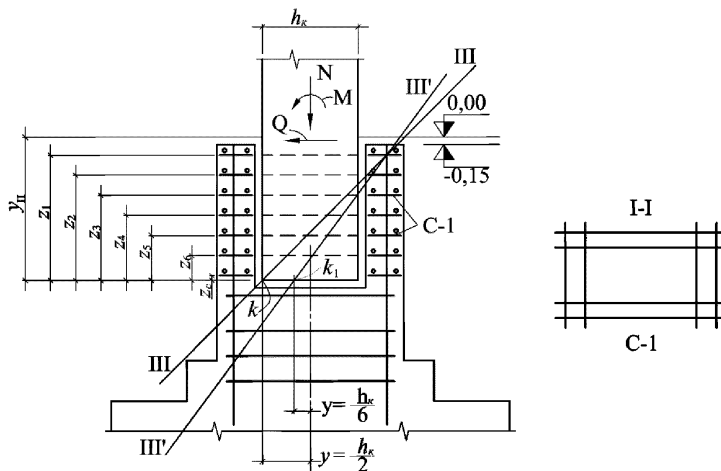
Расчетная схема стаканной части подколонника
